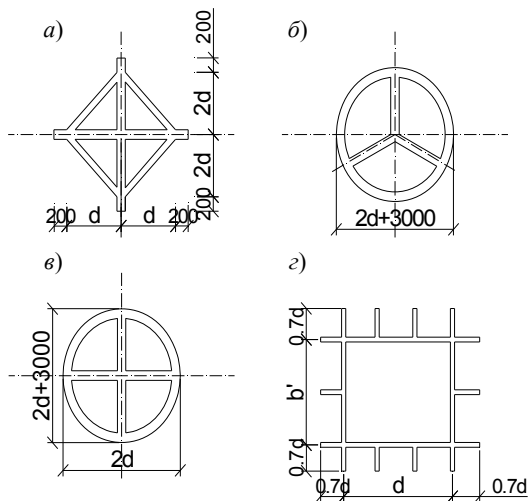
Возможные варианты конструкции железобетонных фундаментов опор ВЛ (НИИСК)
